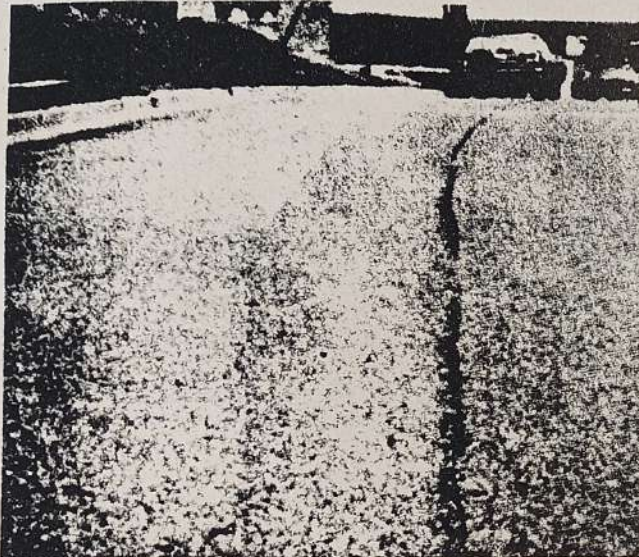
Grieta de Junta de Carril.
